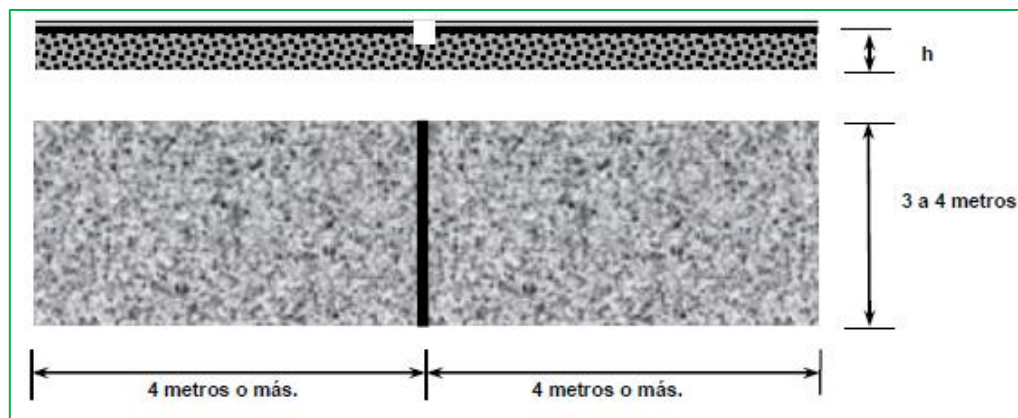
Pavimento de concreto compactado. Fuente: Curso sobre Pavimentos de Concreto Hidráulico. (Ref. Bibliografía 8)
